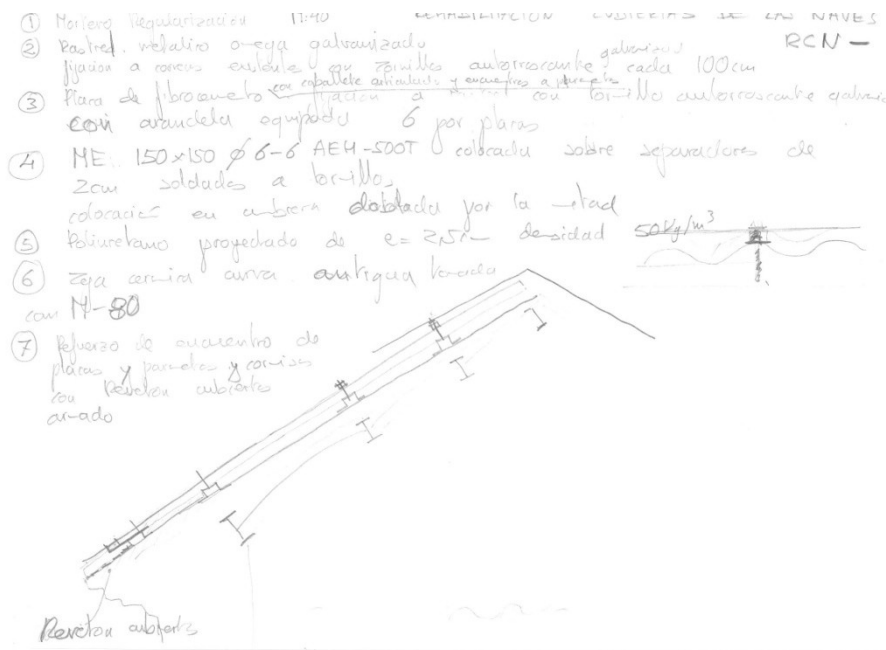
Croquis del autor, una opción de refuerzo estructural de las cubiertas principales
